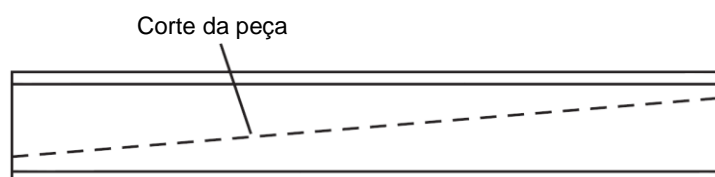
Corte de perfis para reforços (adaptado de Structural Design of Steelwork, 2008)
